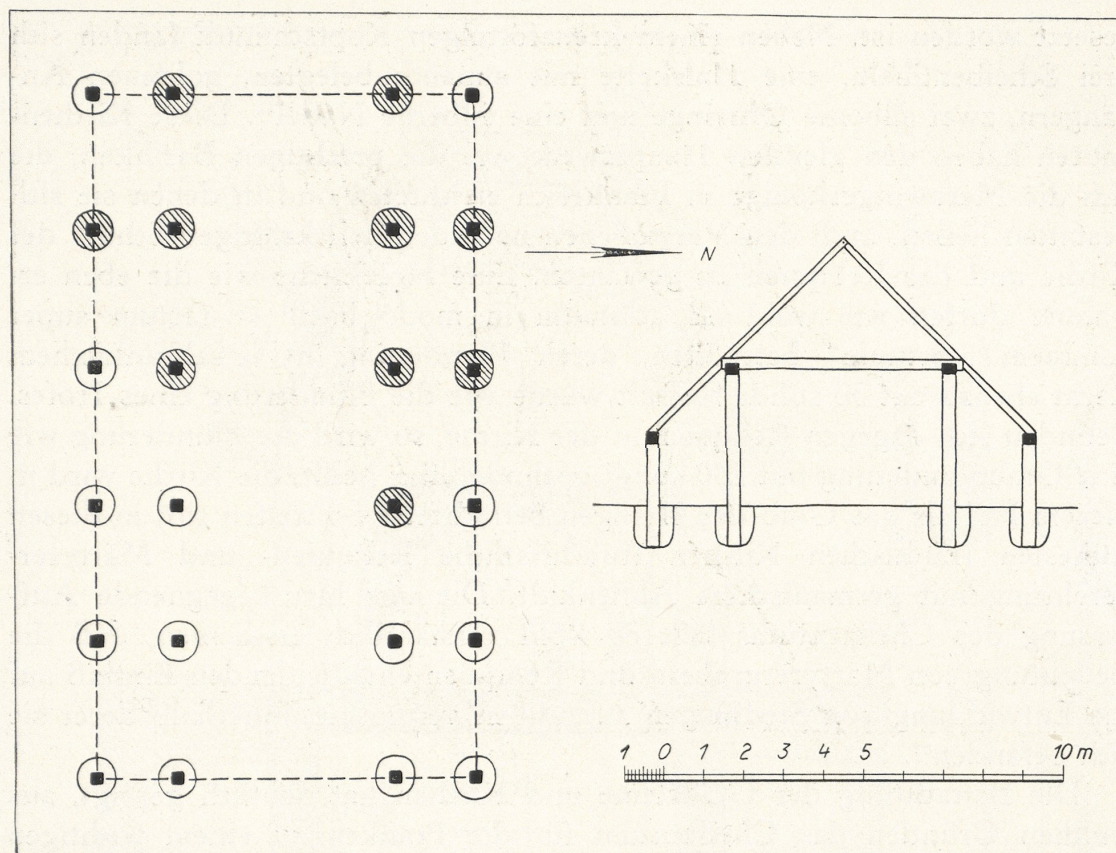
Breberen. Planskizze und Rekonstruktionsversuch der frühen Holzkirche
